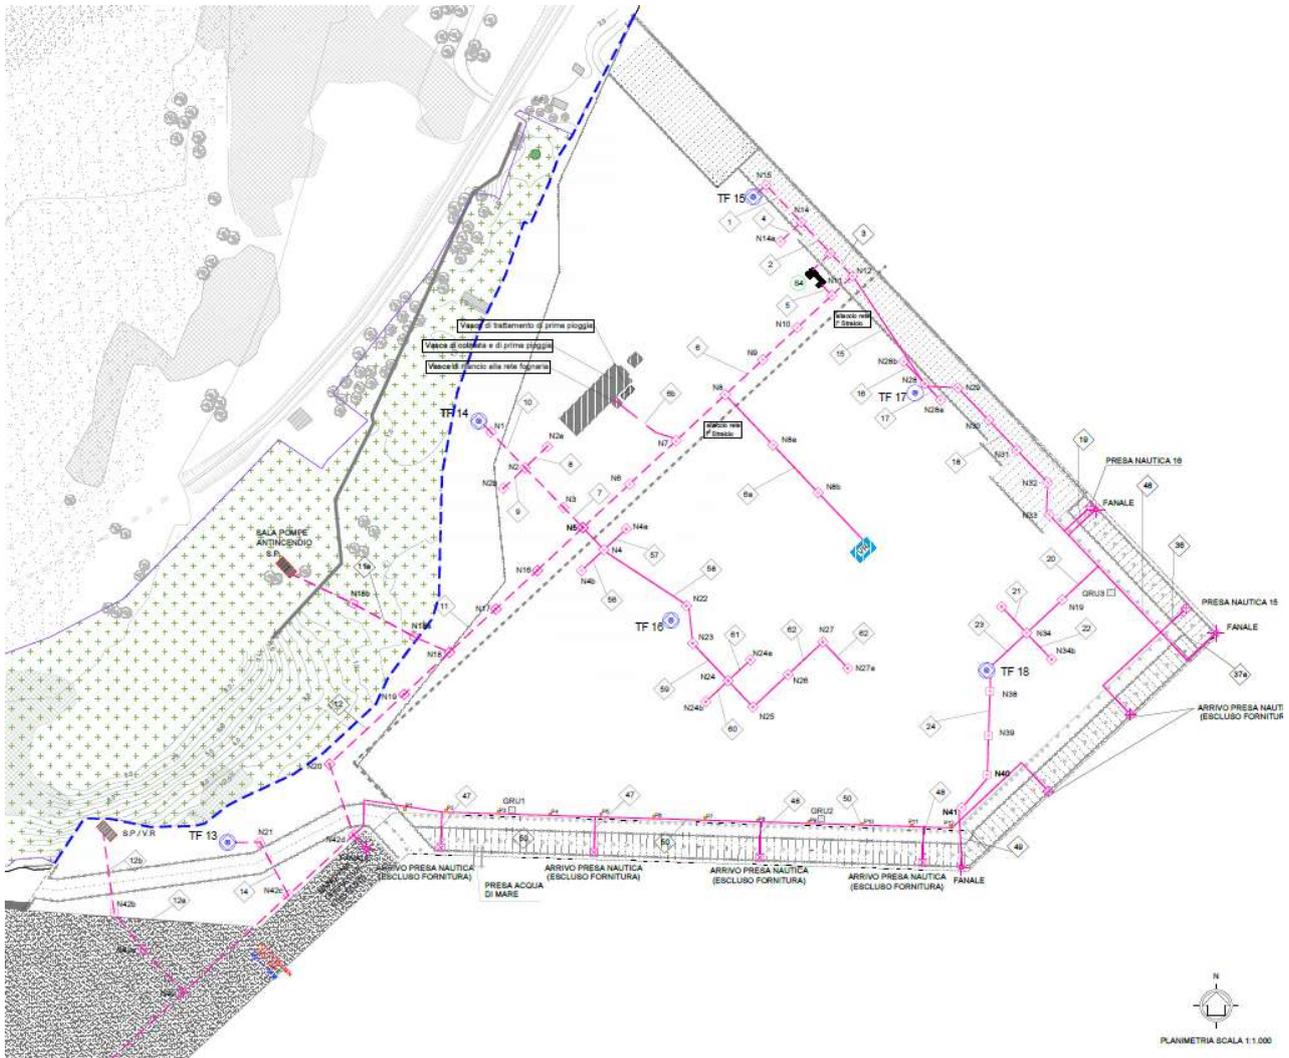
Planimetria rete elettrica esterna – Perizia di Variante
